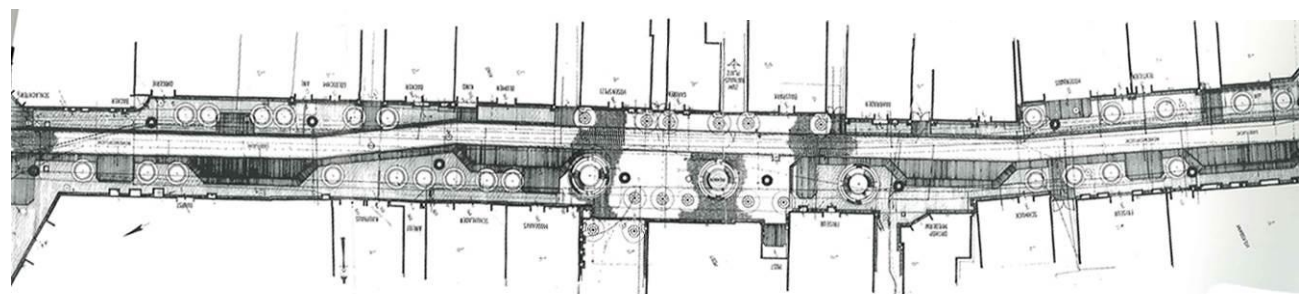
Gestaltungsplan Rathausplatz (o.l.), Bahnhofstraße wird zur Brunnenstraße (o.r. und Mitte), Gestaltungsplan Brunnenstraße 1985 (unten) (Q.: Stadt Bremervörde (1996): Sanierungsgebiet "Innenstadt (I)"
